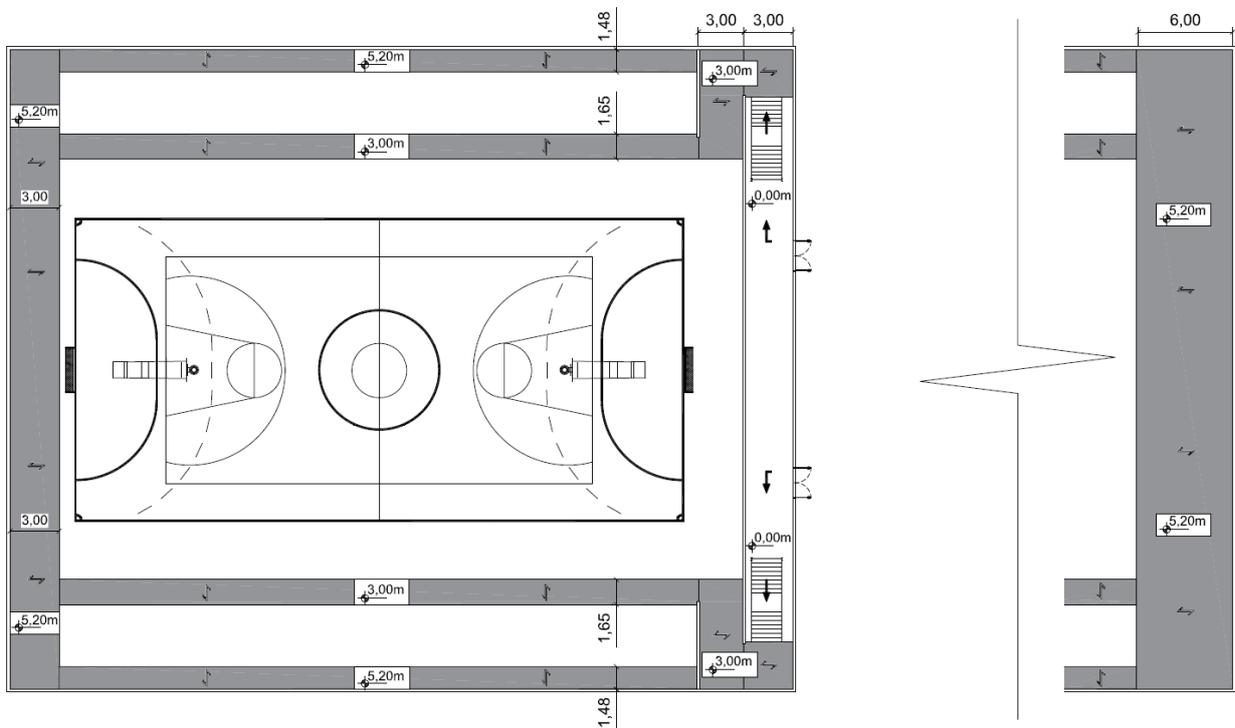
Izquierda: forjado entreplanta / Derecha: forjado primera planta zona aseos.
